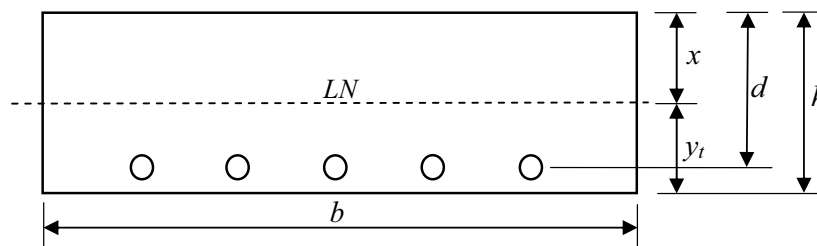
Parâmetros de cálculo da carga de fissuração.
